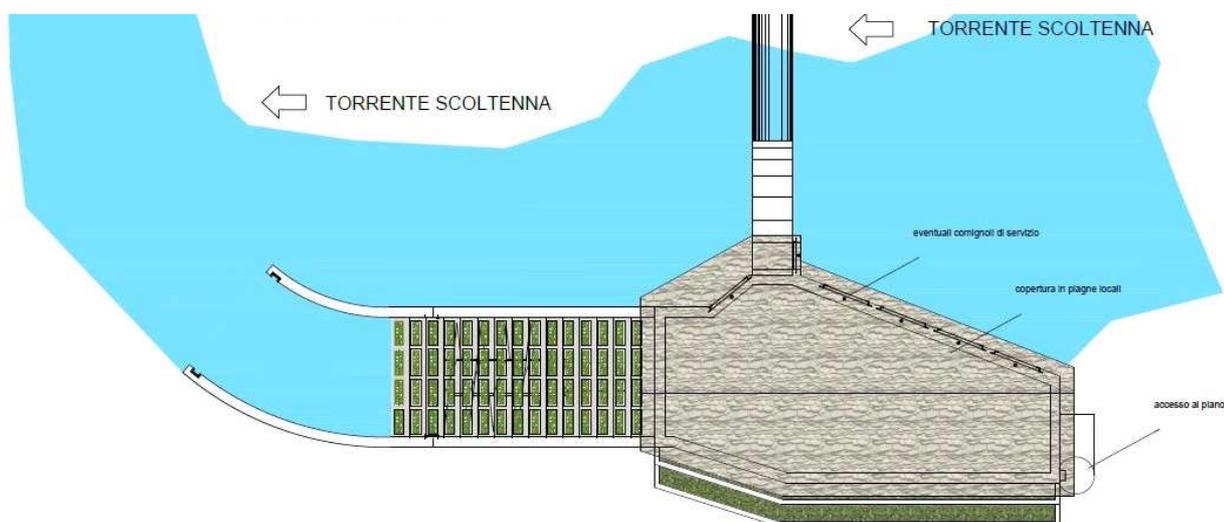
Pianta delle coperture_ Estratto Elaborato 016 Piante, sezioni e prospetti della centralina
